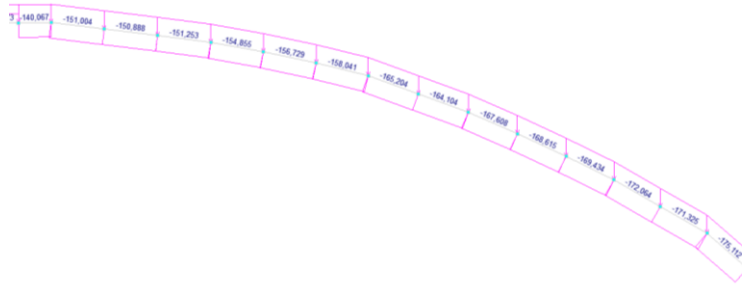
Схема загрузки весом элементов расчётной схемы
